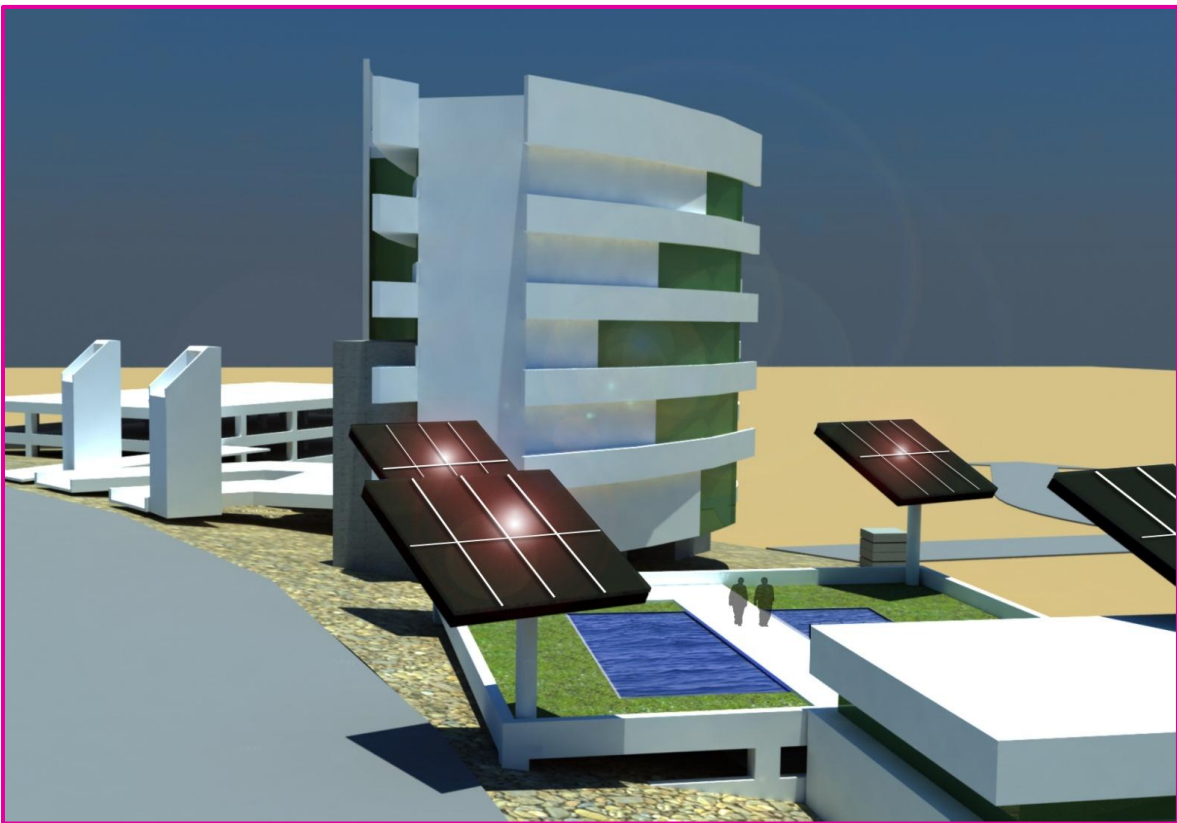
PRIMER PARTIDO ARQUITECTÓNICO. EDIFICIO CENTRAL.
